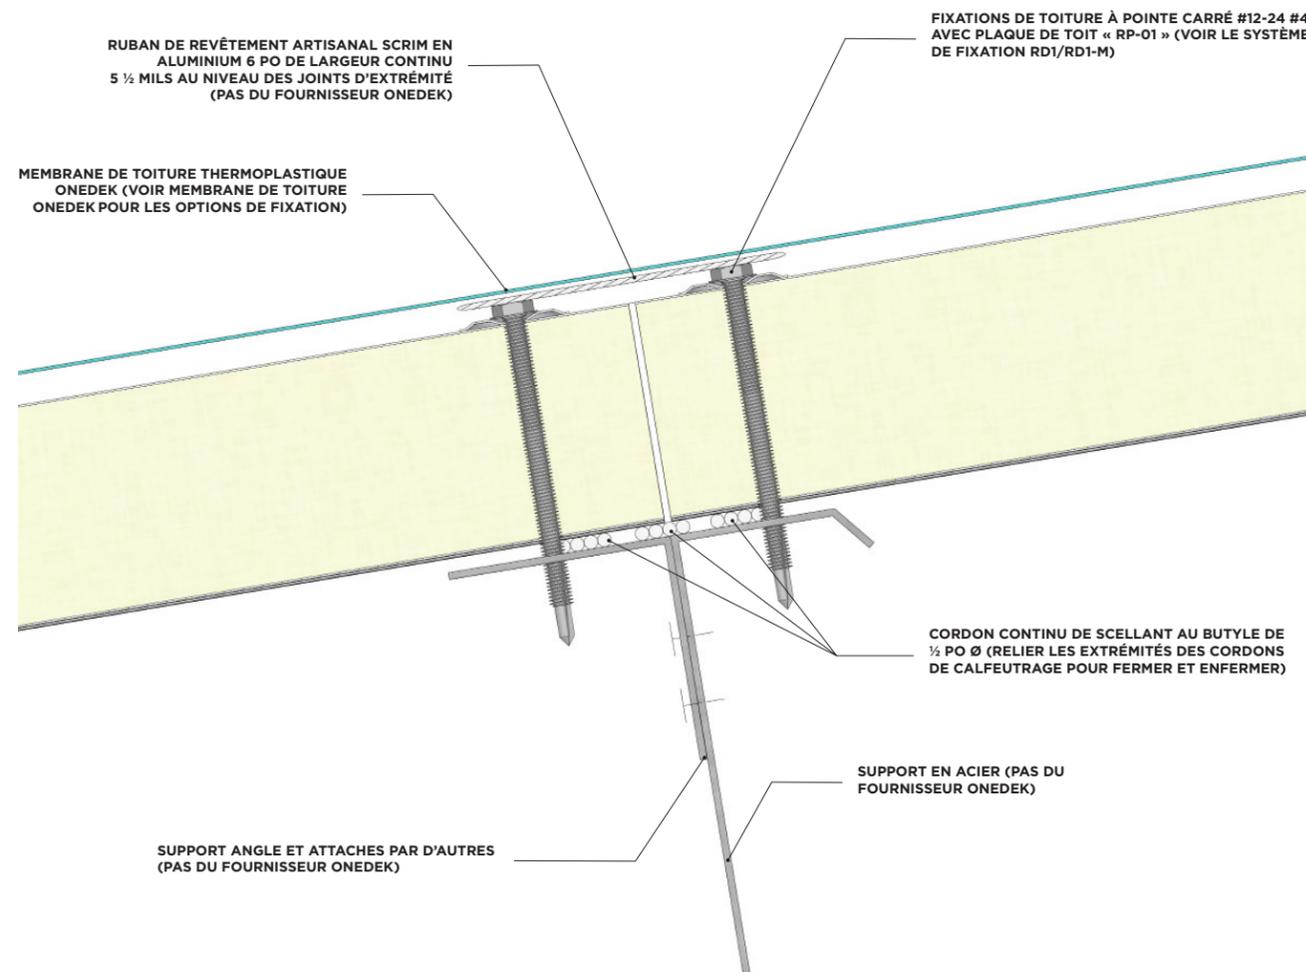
DÉTAIL DU JOINT BOUT À BOUT (VUE EN COUPE)
